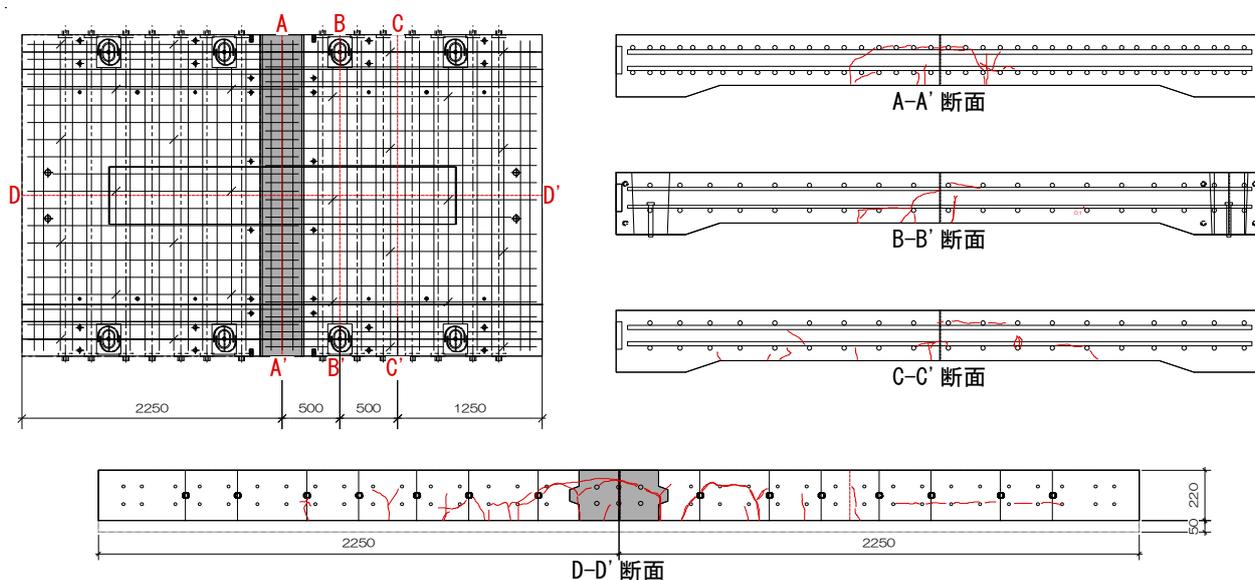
試験終了後の試験体切断面におけるひび割れ性状
